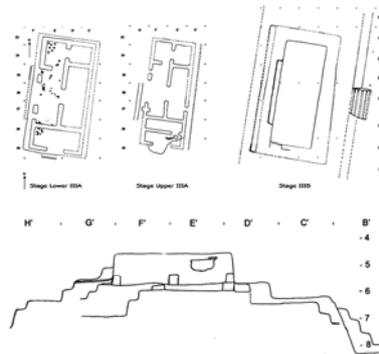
Planta y corte de la Plataforma Este (Daneels, 2008).
